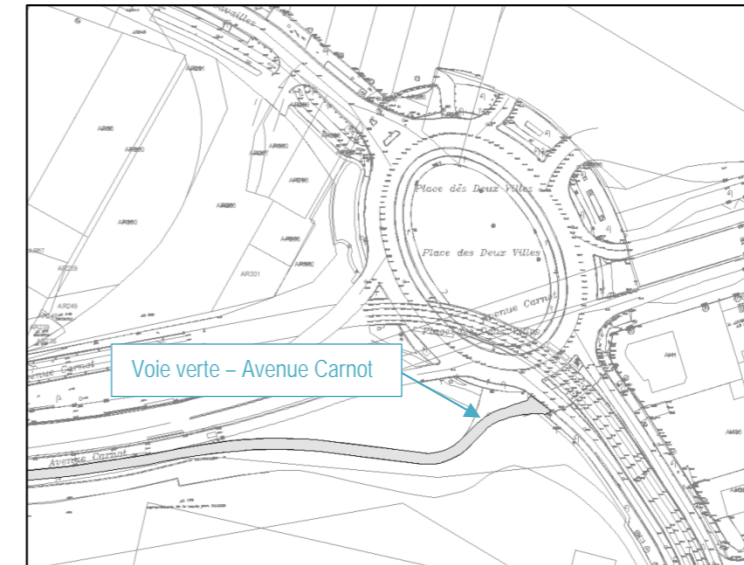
Raccordement Voie Verte Av. Carnot au Giratoire Carnot / Cavailles / Pelletan (Source : Plans EXE – Guintoli)
